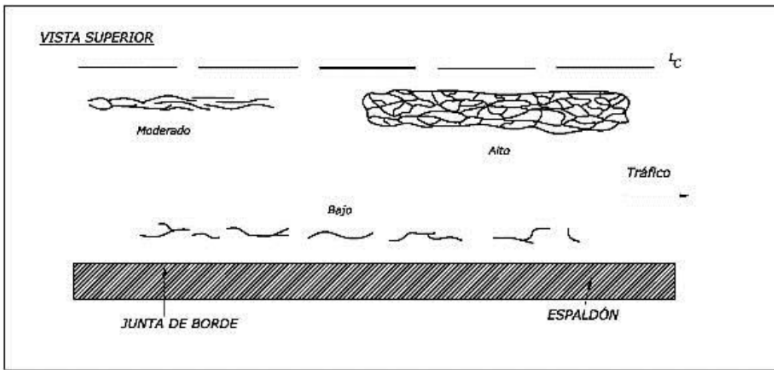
Esquema Cuero de Lagarto- Pavimento Flexible
